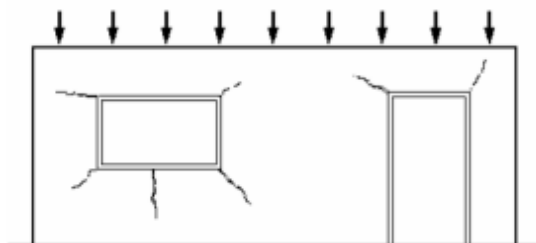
Fissuração por sobrecarga localizada.
